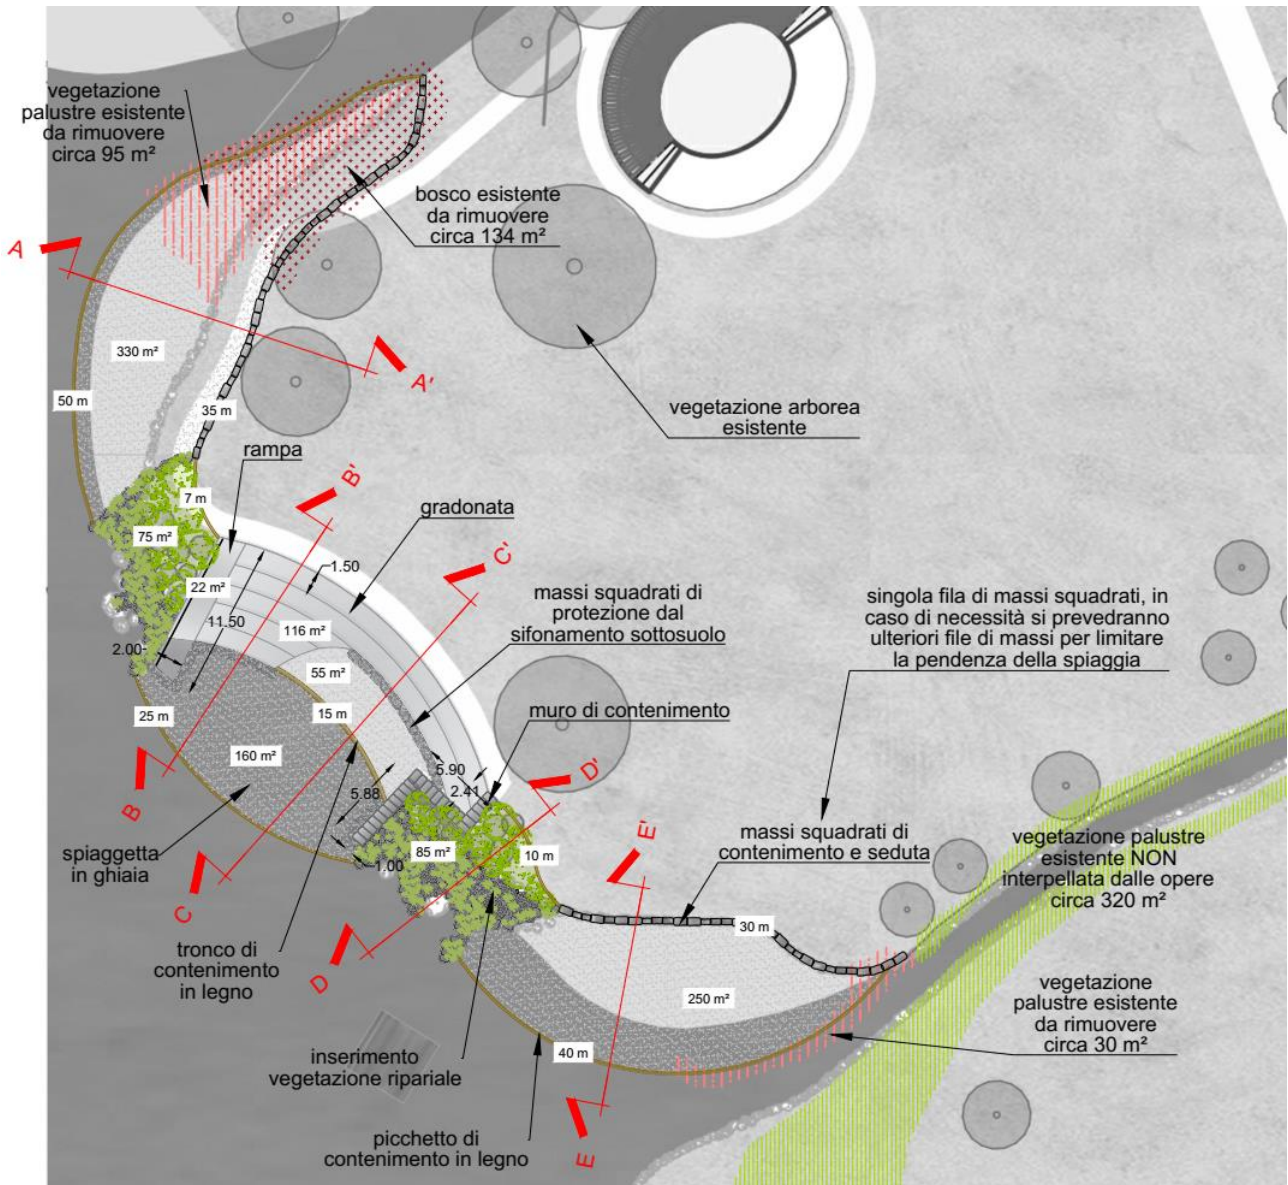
Zoom planimetria di progetto area nord con indicazione sezioni
